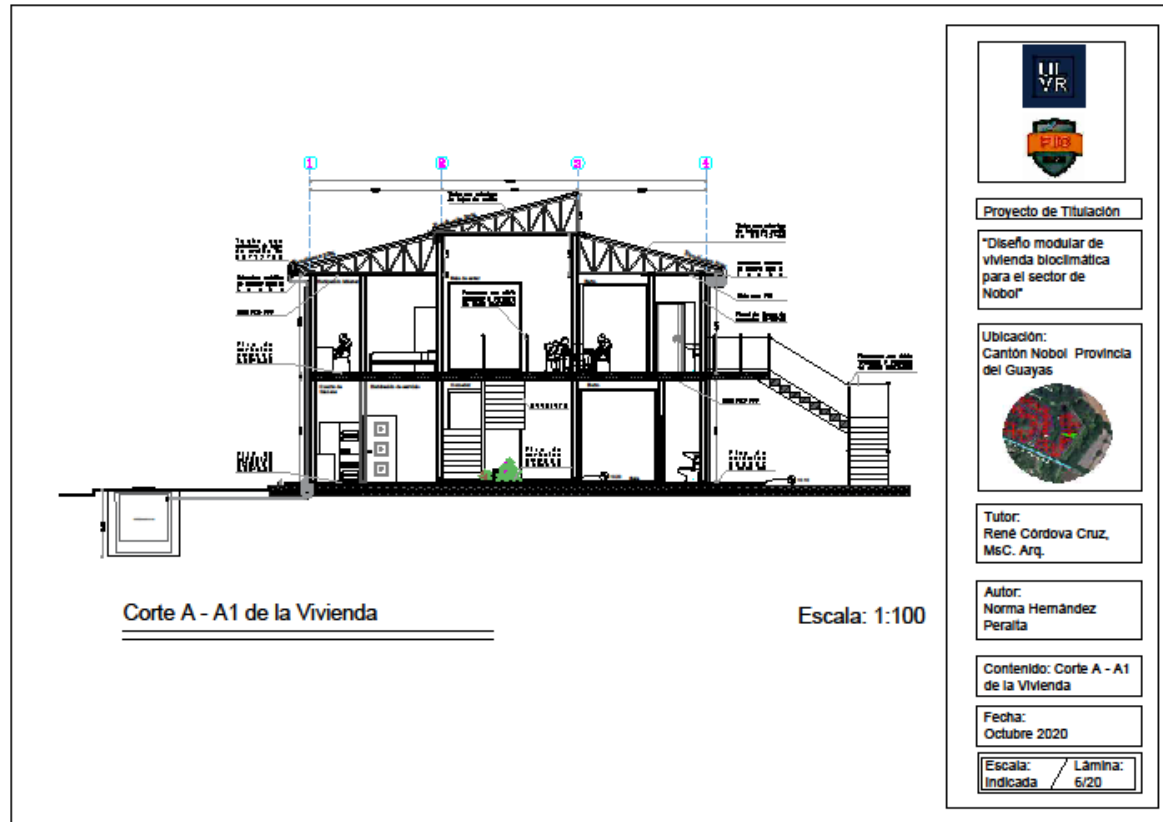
Plano arquitectónico - Corte A-A1 (Escala 1:100)
